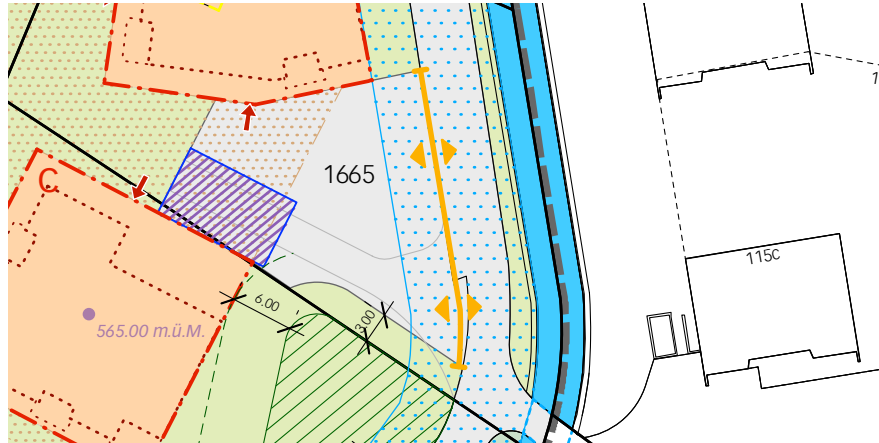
Ausschnitt aus dem Überbauungsplan mit neuer Erschliessung innerhalb des Gewässerraums des Hünibachs
